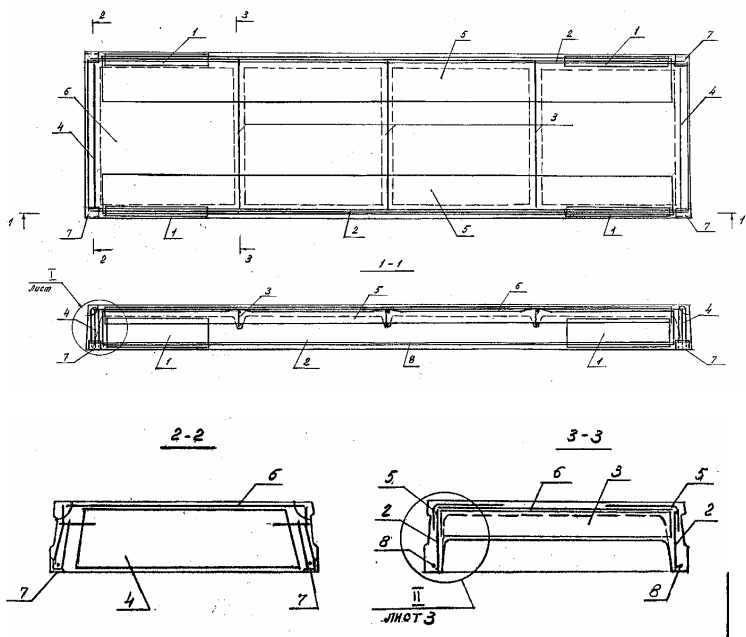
Армирование панели: 1 – сетка усиления зоны передачи напряжений на концевых участках ребер; 2 – каркас с поперечной арматурой продольного ребра; 3 – плоский каркас поперечного ребра; 4 – плоский каркас торцевого ребра; 5 – сетка армирования полки, воспринимающая опорный отрицательный момент; 6 – сетка армирования полки, воспринимающая пролетный момент и опорный момент над поперечным ребром; 7 – опорная закладная деталь со строповочной петлей; 8 – продольная напрягаемая арматура
